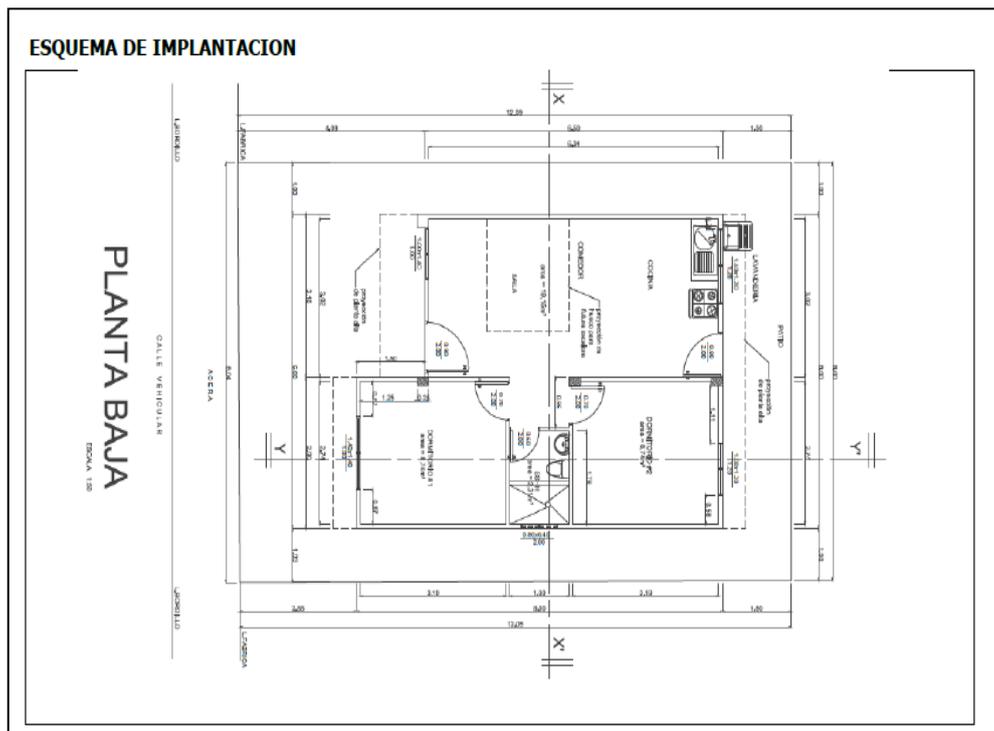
Esquema de Implantación de Vivienda estándar para Plan Habitacional
